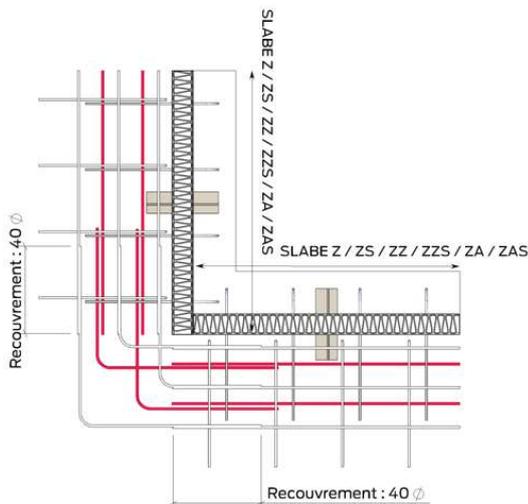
Ferrailage d'un angle sortant (vue en plan)
